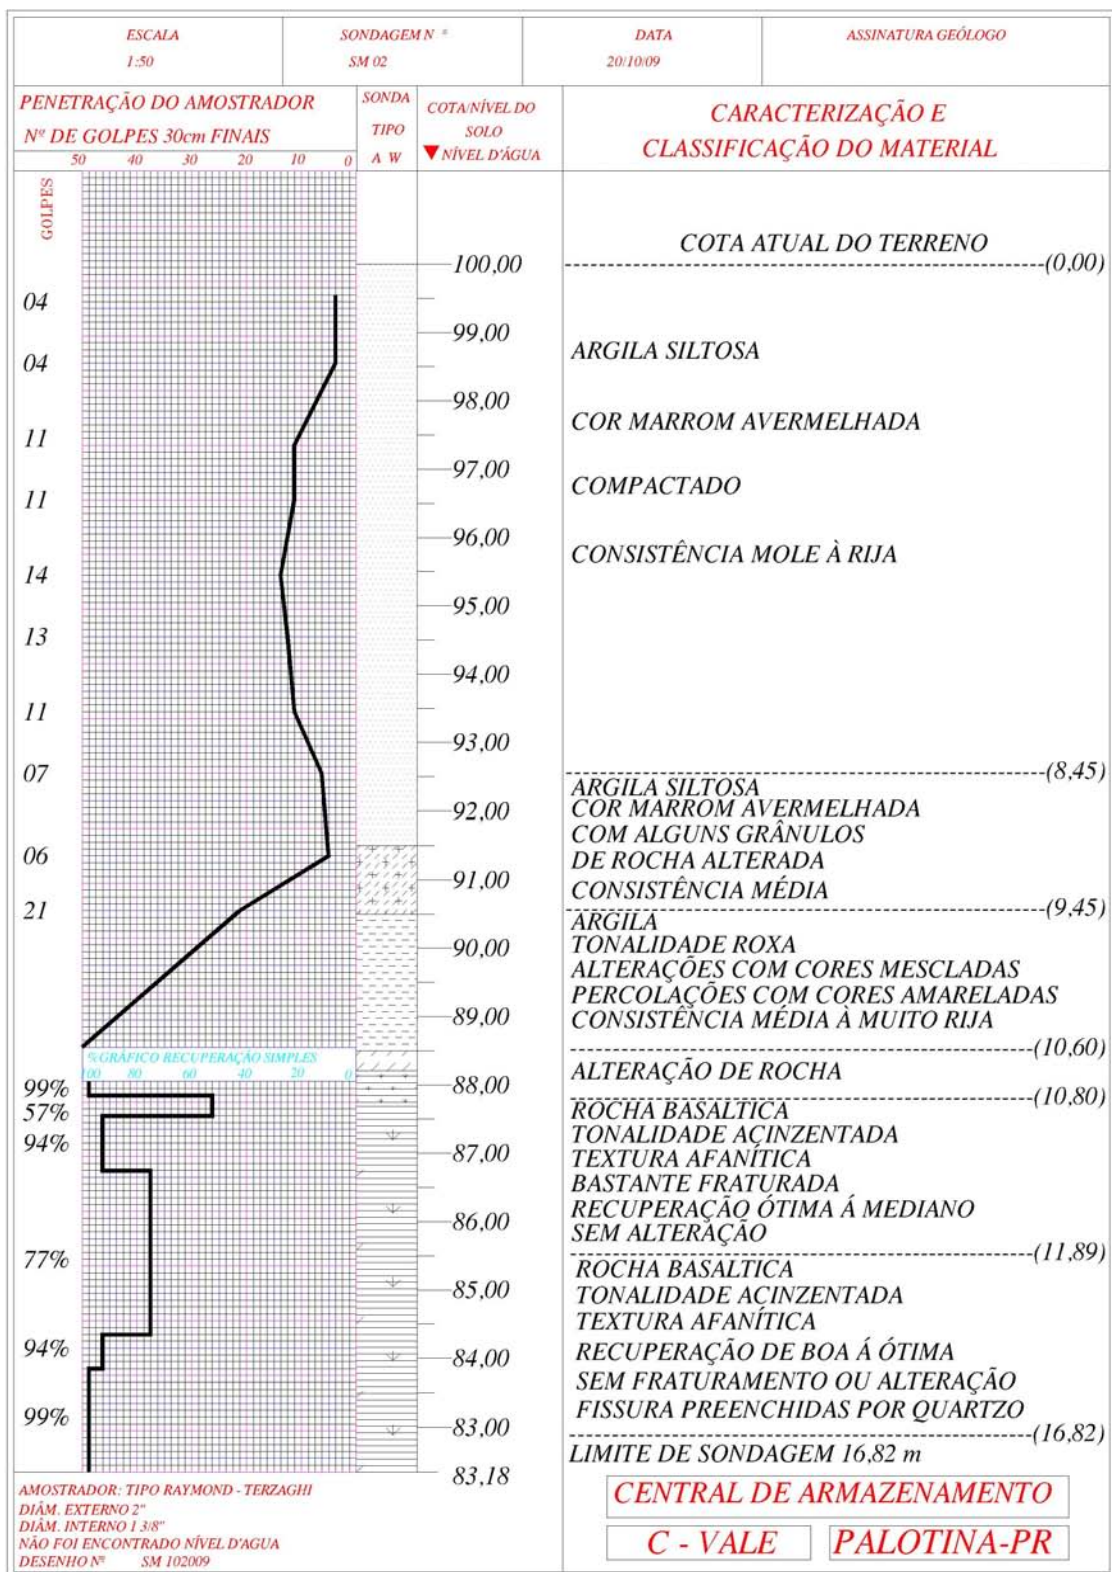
Perfil Sondagem Mista (SM) furo 02.
